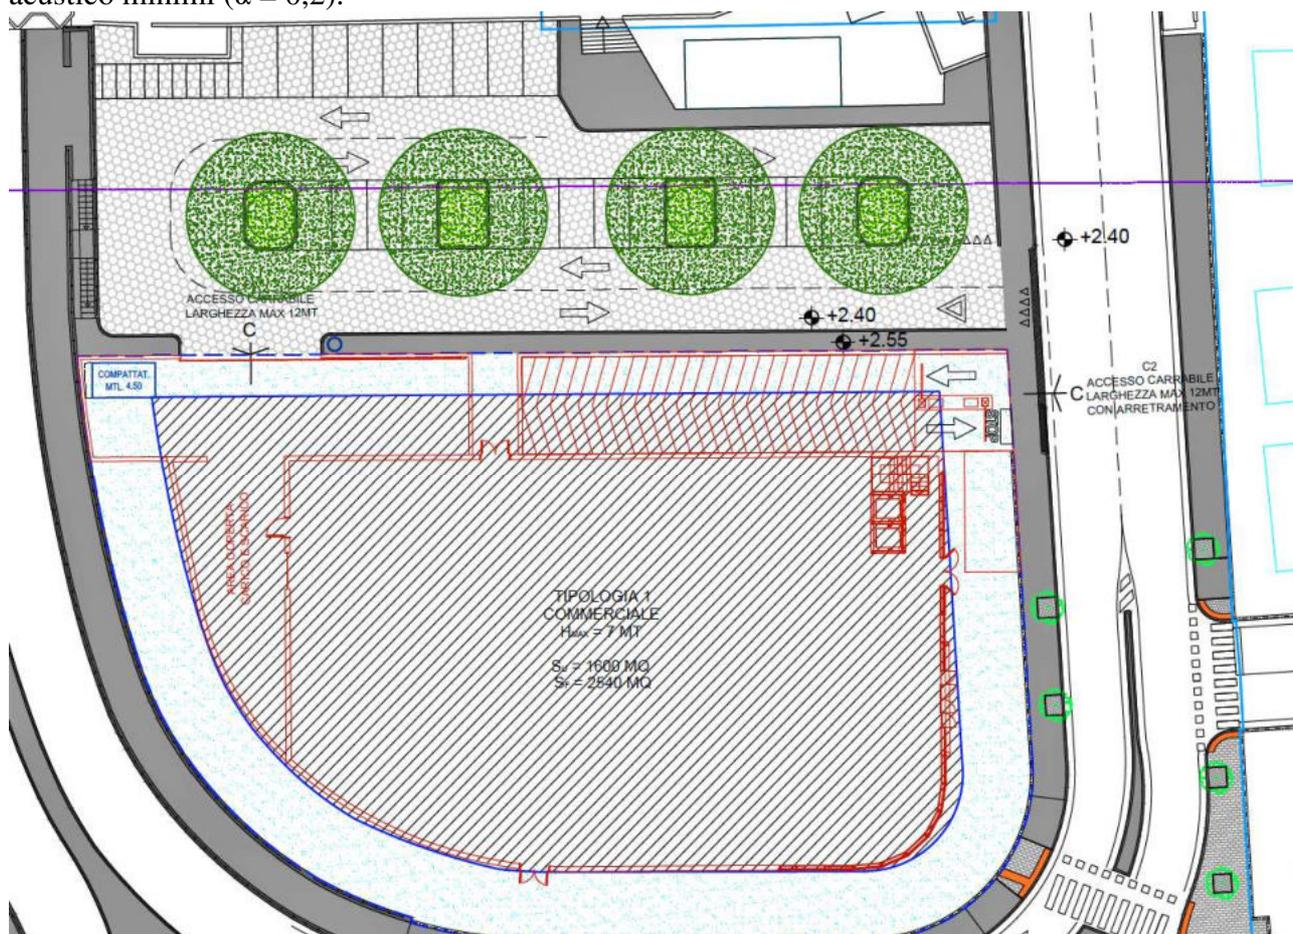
estratto Tavola 8 di progetto – planimetria area commerciale
